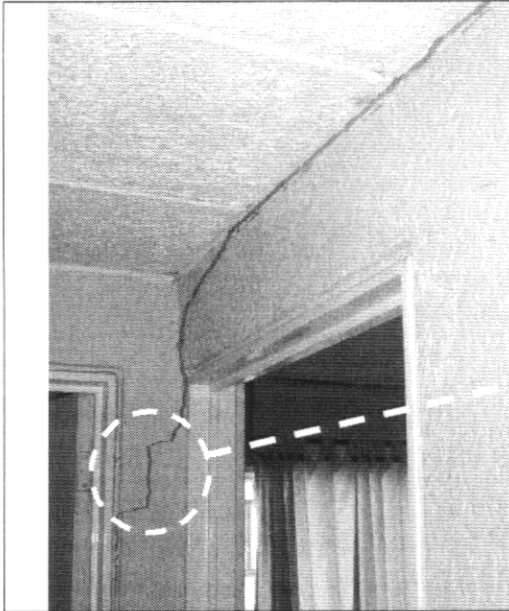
Grieta en punto de contacto entre muro divisorio central segundo nivel y cubierta (11-02-2008).
